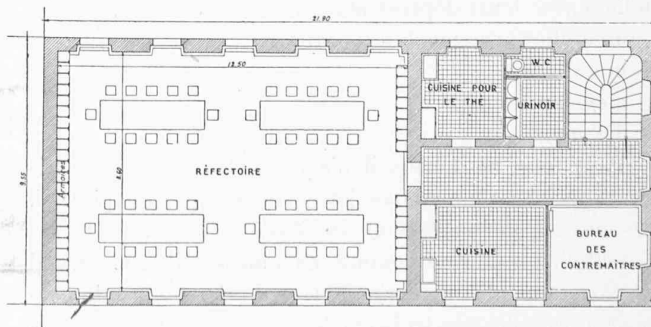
Bâtiment de service. — Plan du premier étage.
